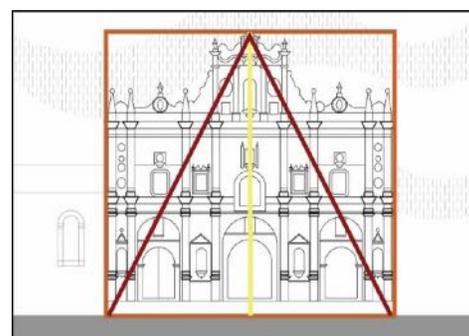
Cuadrado base en la fachada. Fuente: Realizado por el autor.
